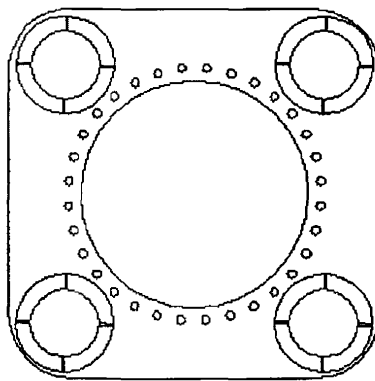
Схема четырёхсвайного фундамента, вид сверху.
